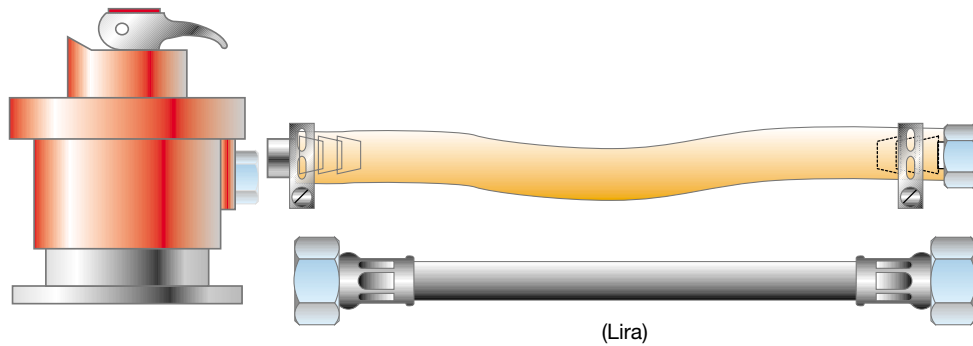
Tubos flexibles no metálicos.
